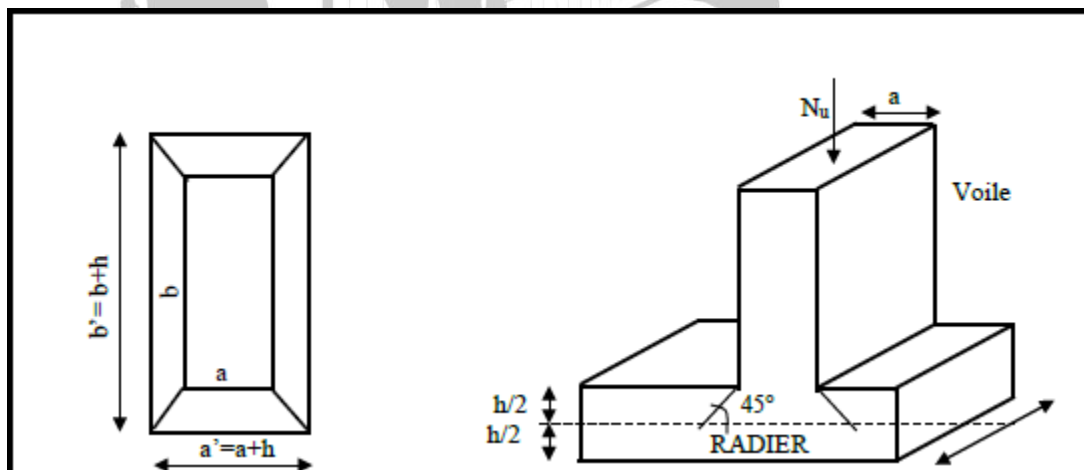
Périmètre utile des voiles et des poteaux.
